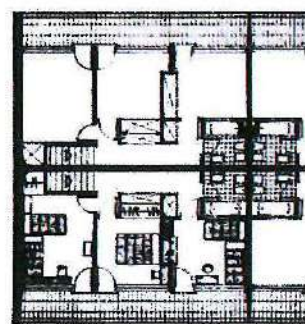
Bairro das Estacas, Planta do piso tipo (duplex), tipo 3. Duplex, 2.^o piso, in Tatiana Branco, op. cit. pág. 65.
